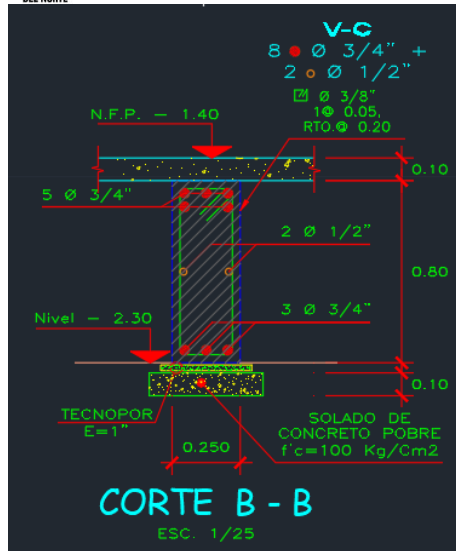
Detalle de Viga de Cimentación (Fuente: Arconsa Contratistas Generales, 2018).
